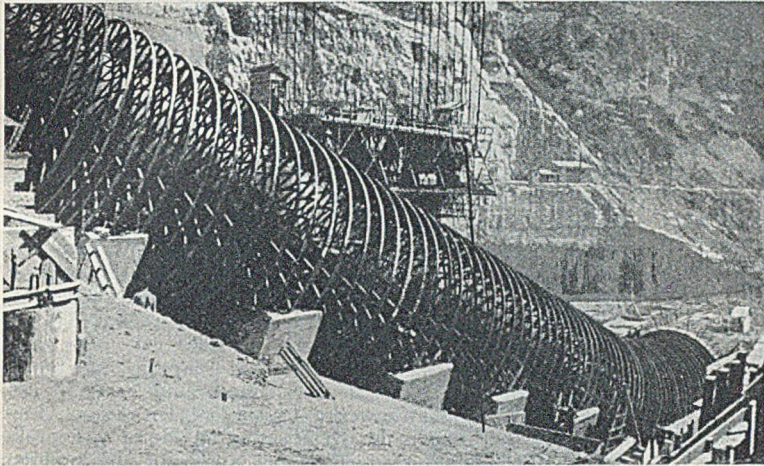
Ansicht der Leitung vor dem Einbetonieren.
